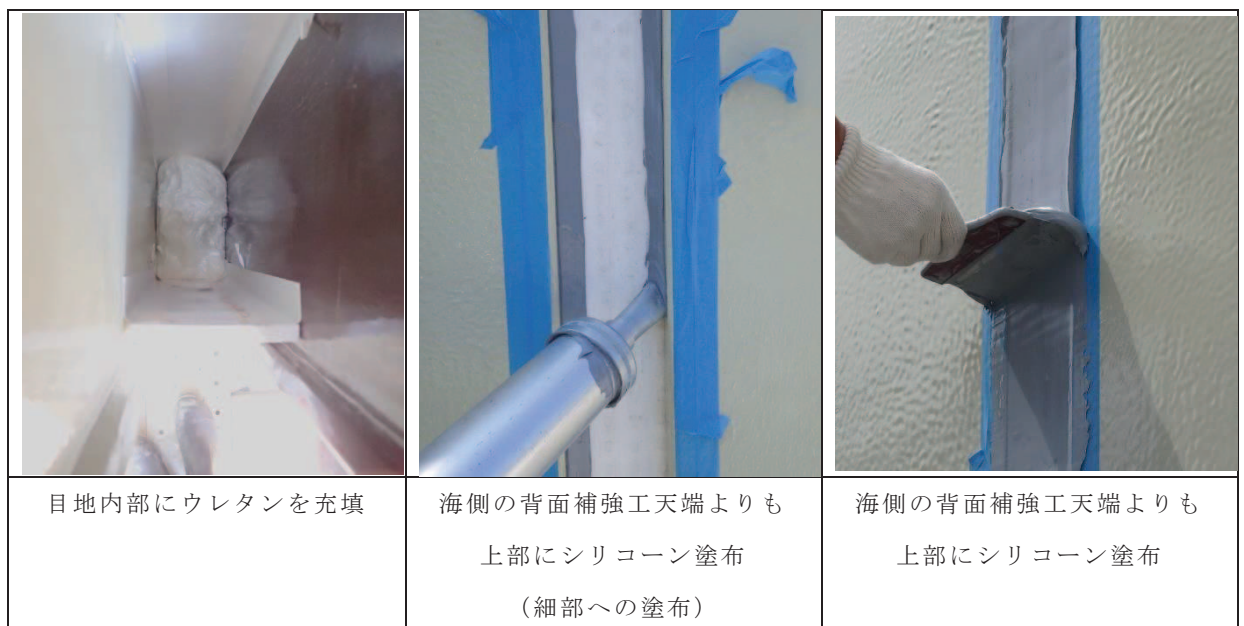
(1) ウレタンシリコーン目地の施工状況
